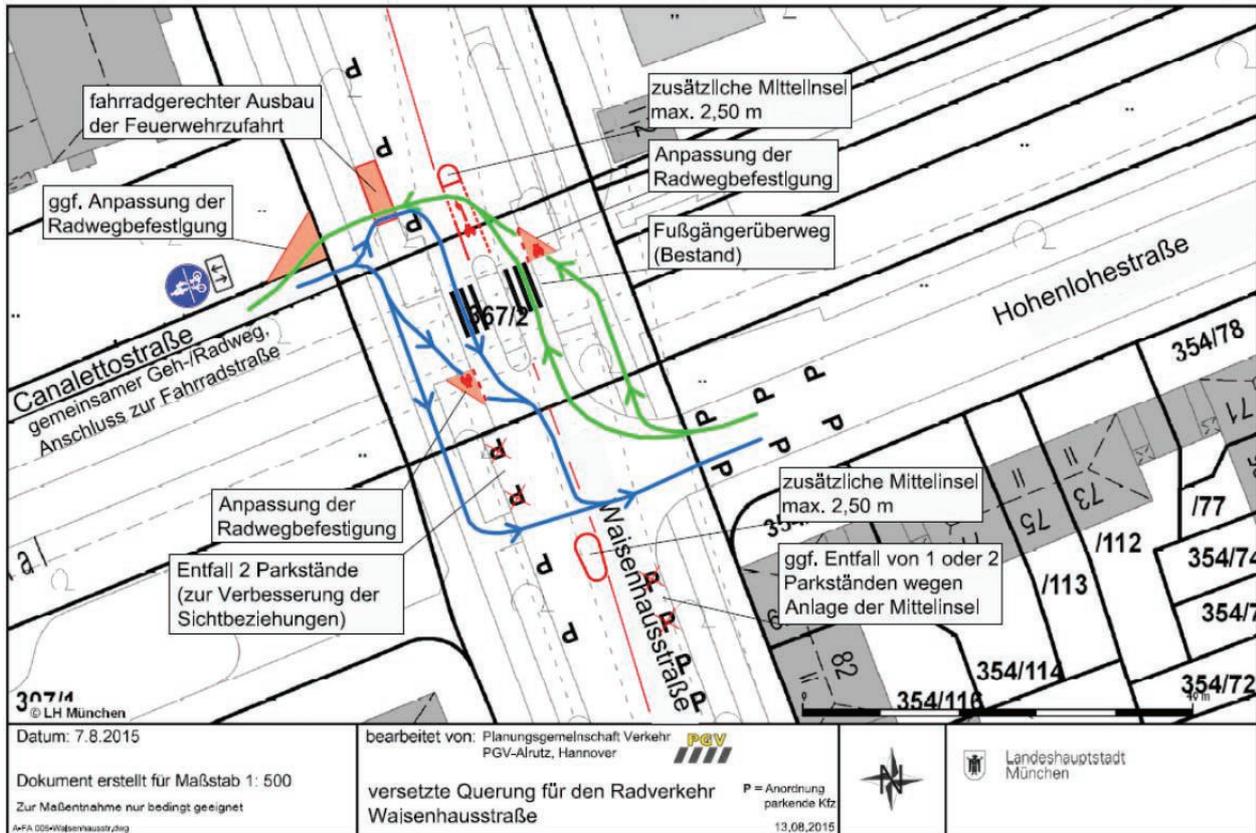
Skizze zur Gestaltung der Querung an der Waisenhausstraße
